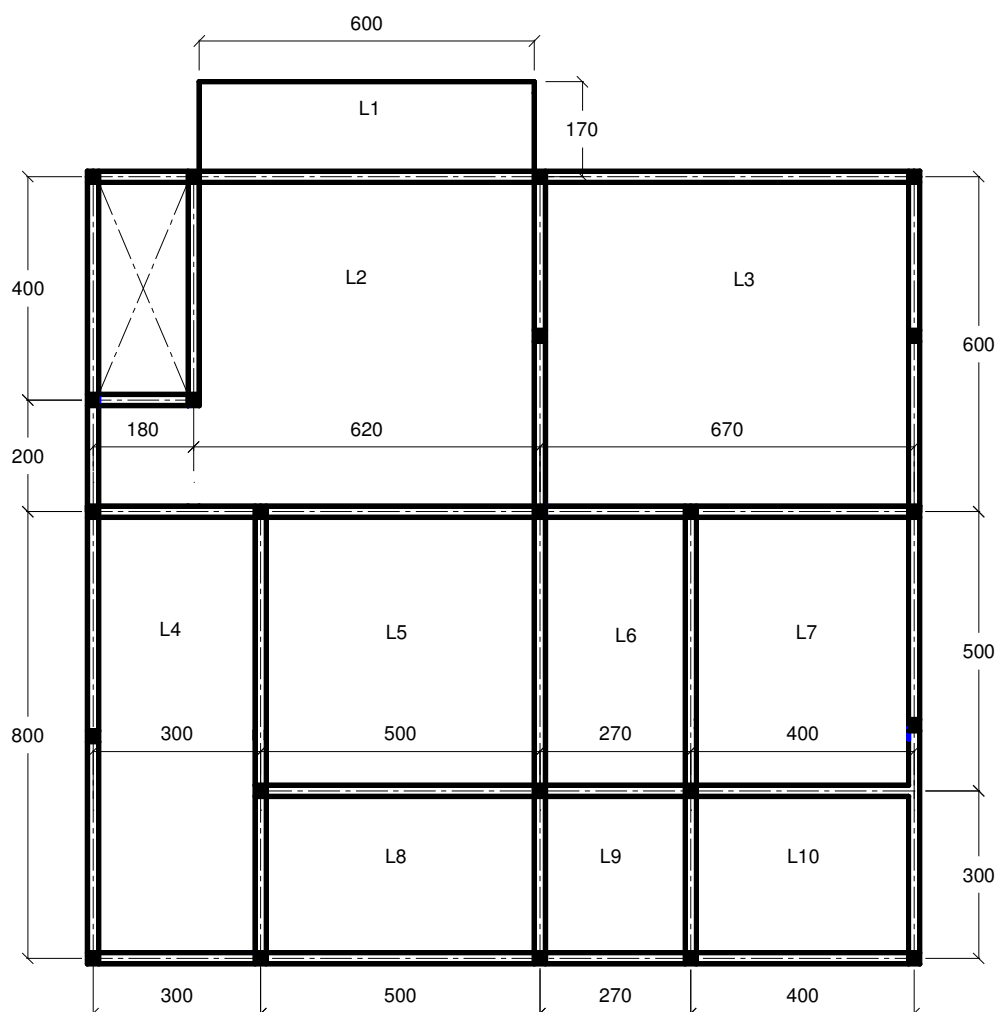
Planta de fôrma simplificada da estrutura do pavimento.
